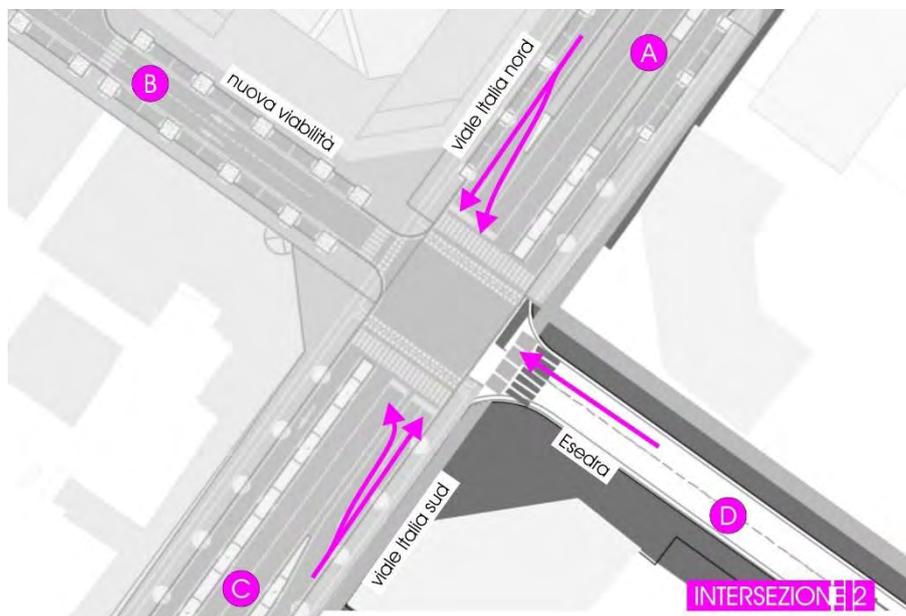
Scenario di Intervento 1 – Planimetria intersezione 2
